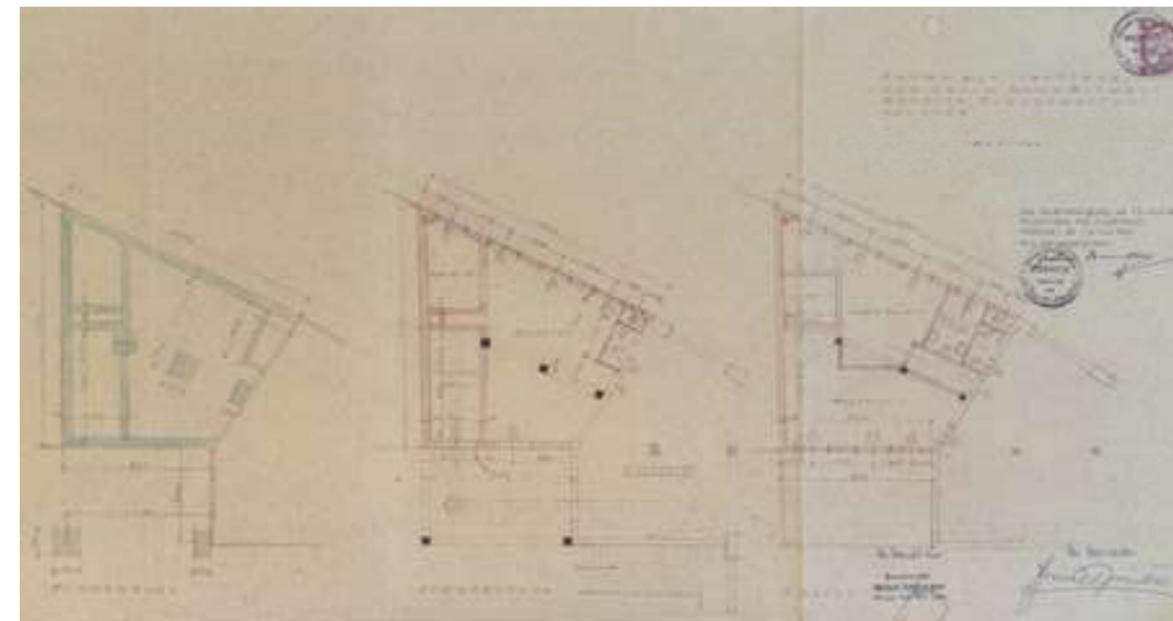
Grundrisse Gebäudeteil 2, 1960
